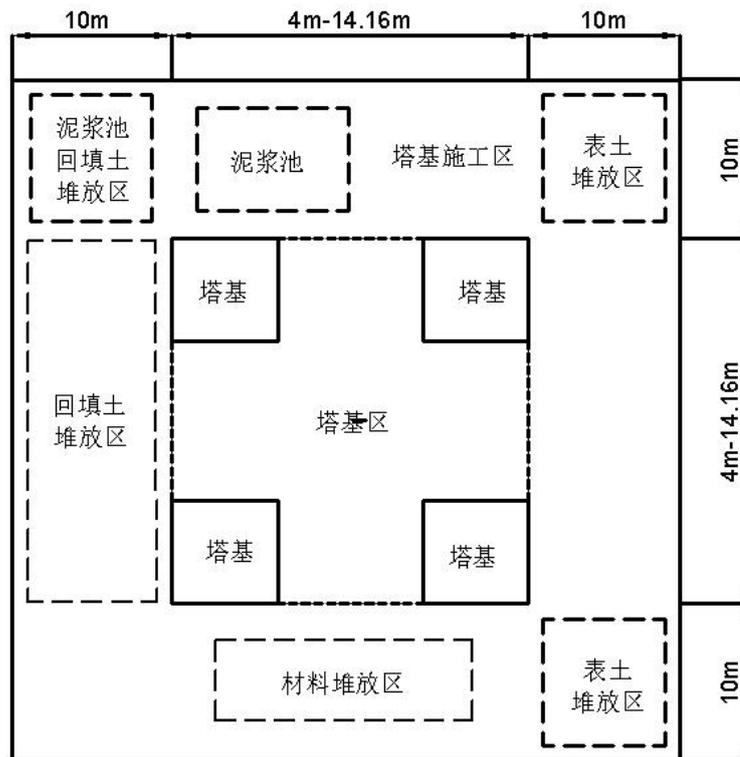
220kV 输电线路塔基及塔基施工区平面图
